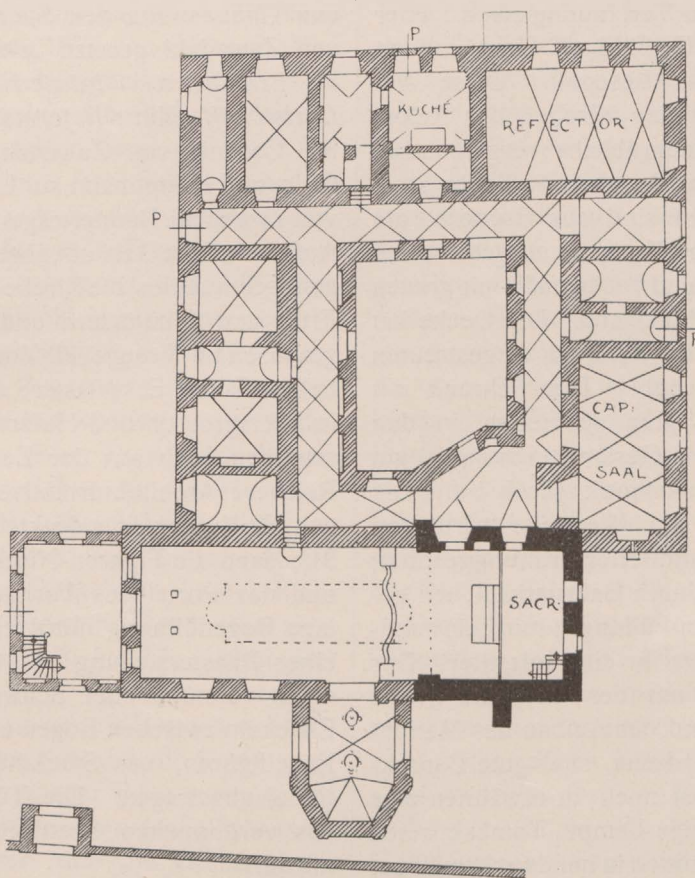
Christburg. Erdgeschoß-Grundriß des Klosters. M. 1 : 400.
